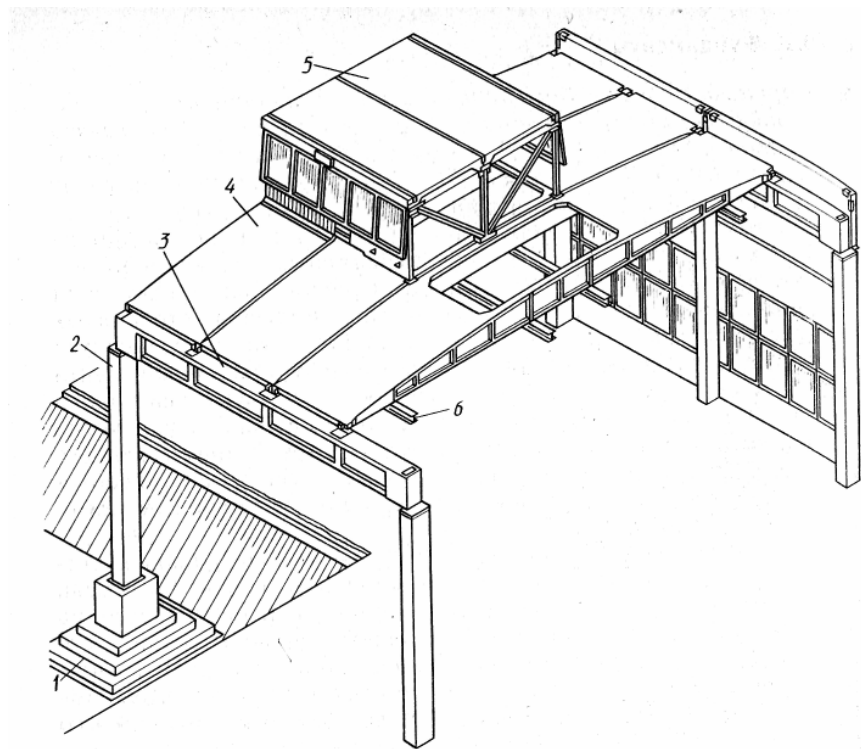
Залізобетонний каркас з плитами «на проліт».
